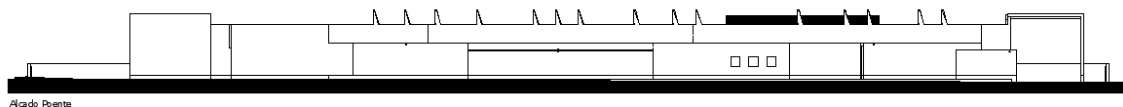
Localização das claraboias na fachada poente (Fonte: Projeto de Arquitetura)
